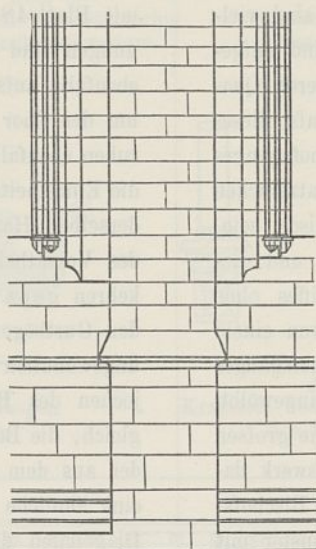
Außen-Ansicht der Seitenschiffsmauern.
